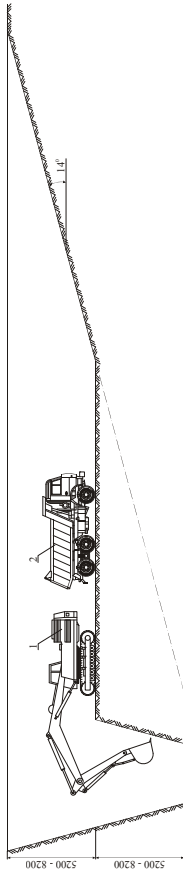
Отрывка котлована: 1 – экскаватор; 2 – самосвал
